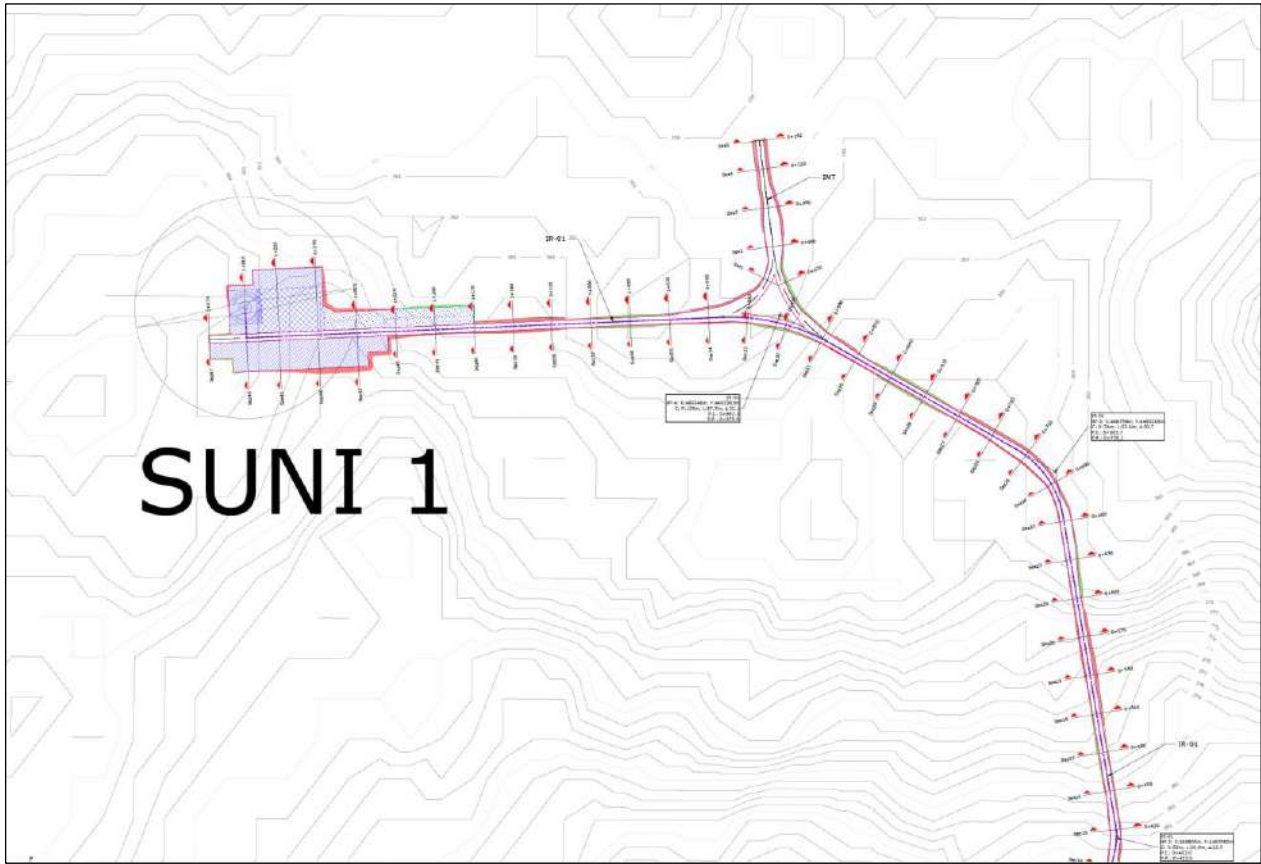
Tracciato planimetrico viabilità di nuova realizzazione.
